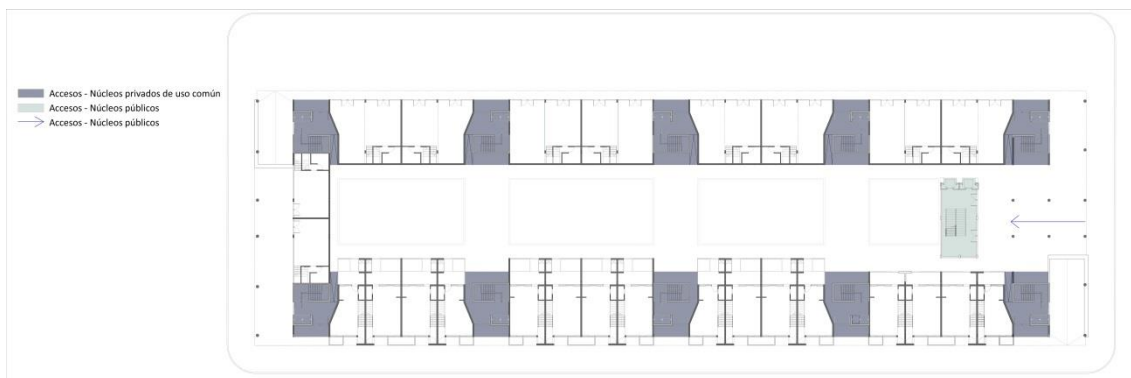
Esquema de planta baja – acceso al núcleo del puente de equipamientos.
